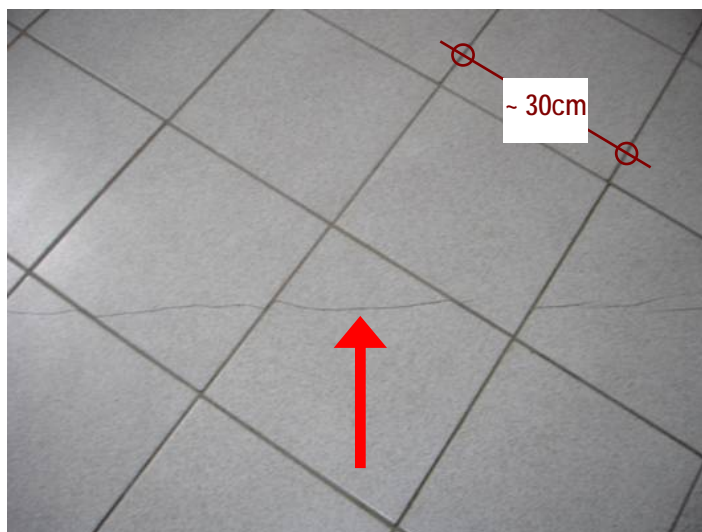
fissura na diagonal do dormitório na parte superior da laje
